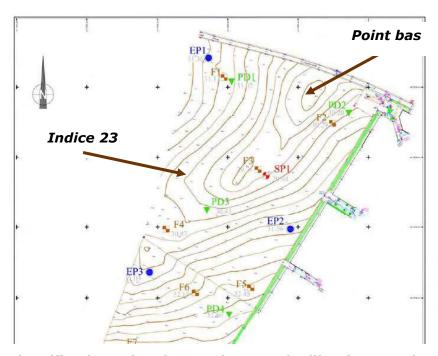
Plan d'implantation des sondages et fouilles (ECR environnement)
